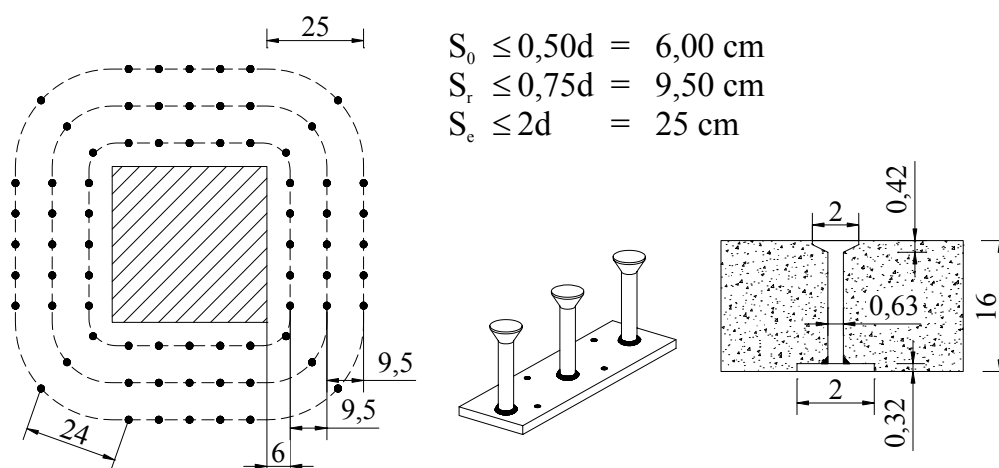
Arranjo da armadura de punção para o pilar P5
